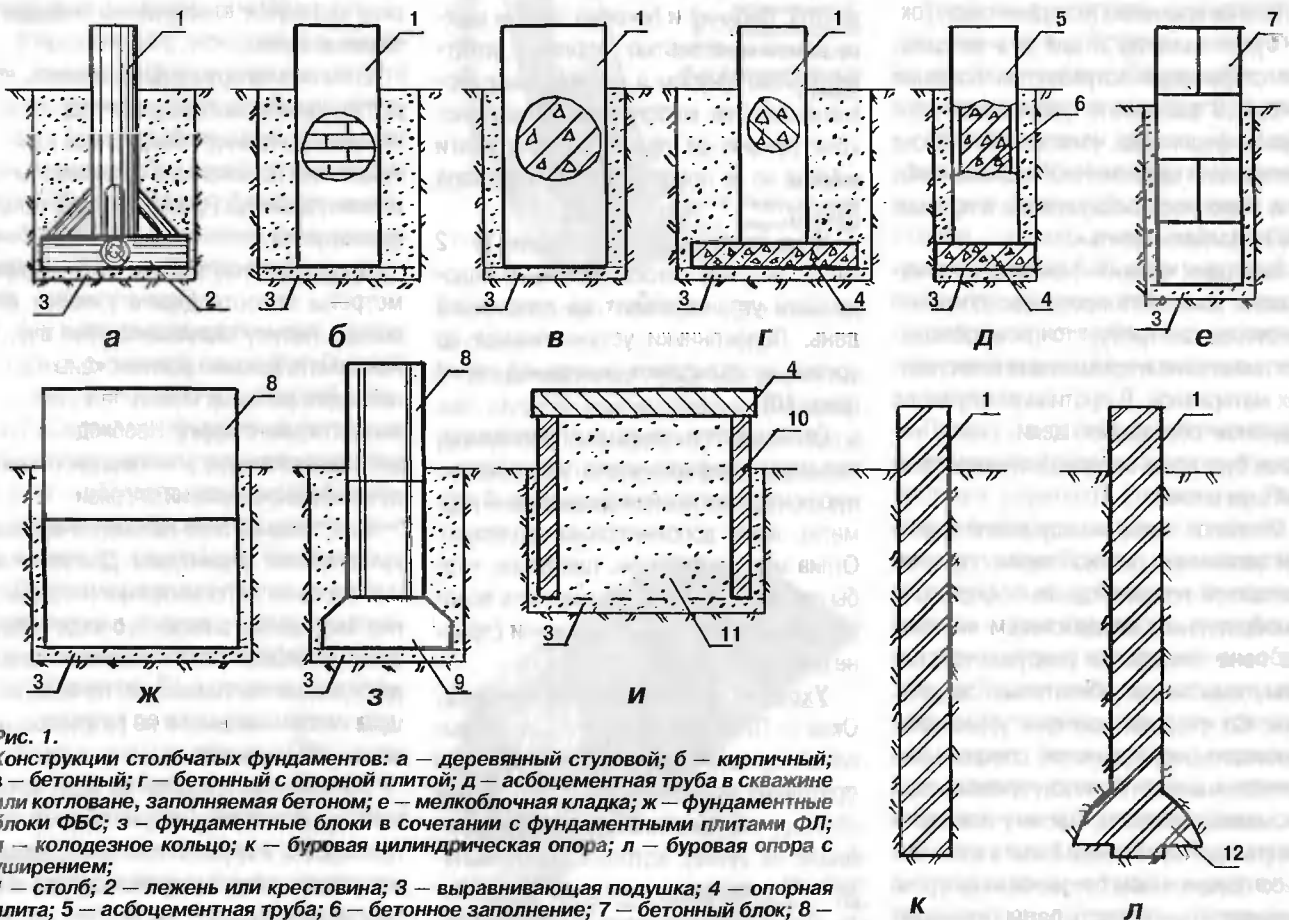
Конструкции столбчатых фундаментов: а — деревянный стуловой; б — кирпичный; в — бетонный; г — бетонный с опорной плитой; д — асбоцементная труба в скважине или котловане, заполняемая бетоном; е — мелкоблочная кладка; ж — фундаментные блоки ФБС; з — фундаментные блоки в сочетании с фундаментными плитами ФЛ; и — колодезное кольцо; к — буровая цилиндрическая опора; л — буровая опора с уширением; 1 — столб; 2 — лежень или крестовина; 3 — выравнивающая подушка; 4 — опорная плита; 5 — асбоцементная труба; 6 — бетонное заполнение; 7 — бетонный блок; 8 — фундаментный блок; 9 — фундаментная плита; 10 — колодезное кольцо; 11 — уплотненный песок; 12 — буровое уширение
